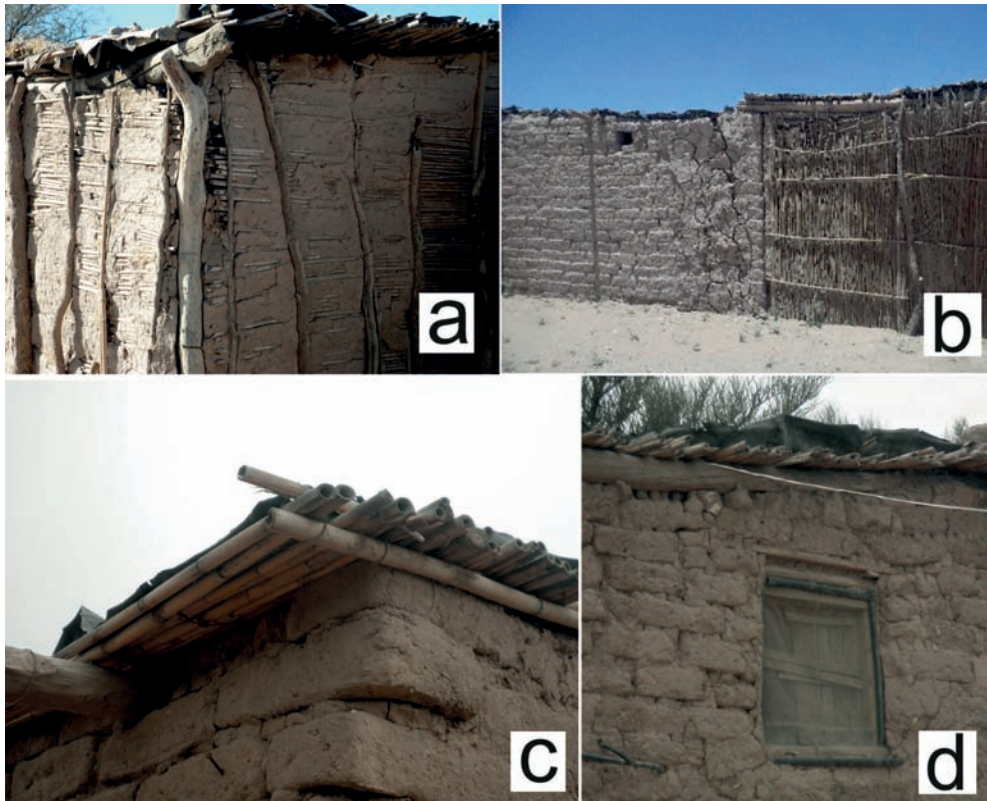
Materiales del espacio cerrado de la casa habitación: a) muro de quincha; b) muro combinado de quincha y adobe; c) detalle de cubierta y materiales empleados y d) ventana con dintel aislado y cierre liviano de nylon sintético por el exterior.
